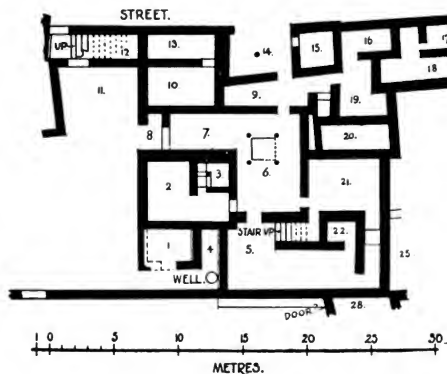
Grundriß eines Hauses in Palaikastro. (S. 105.)
